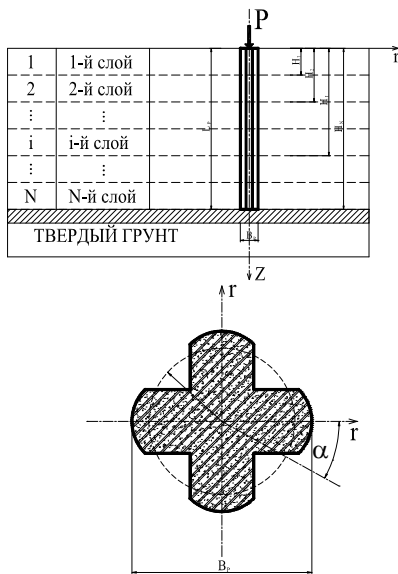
Свая, заглубленная в многослойный грунт с основанием, опирающимся на жесткий грунт.
